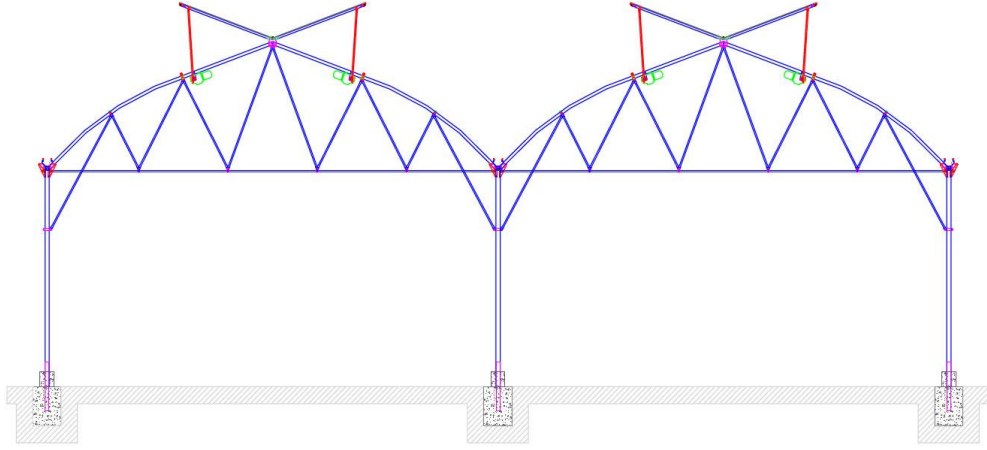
Dekar Alan Sera Vaziyet Planı
